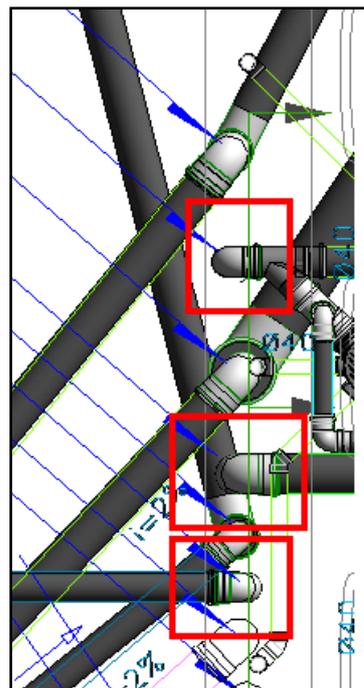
Modelo de esgoto com planta do 1º pavimento visível
